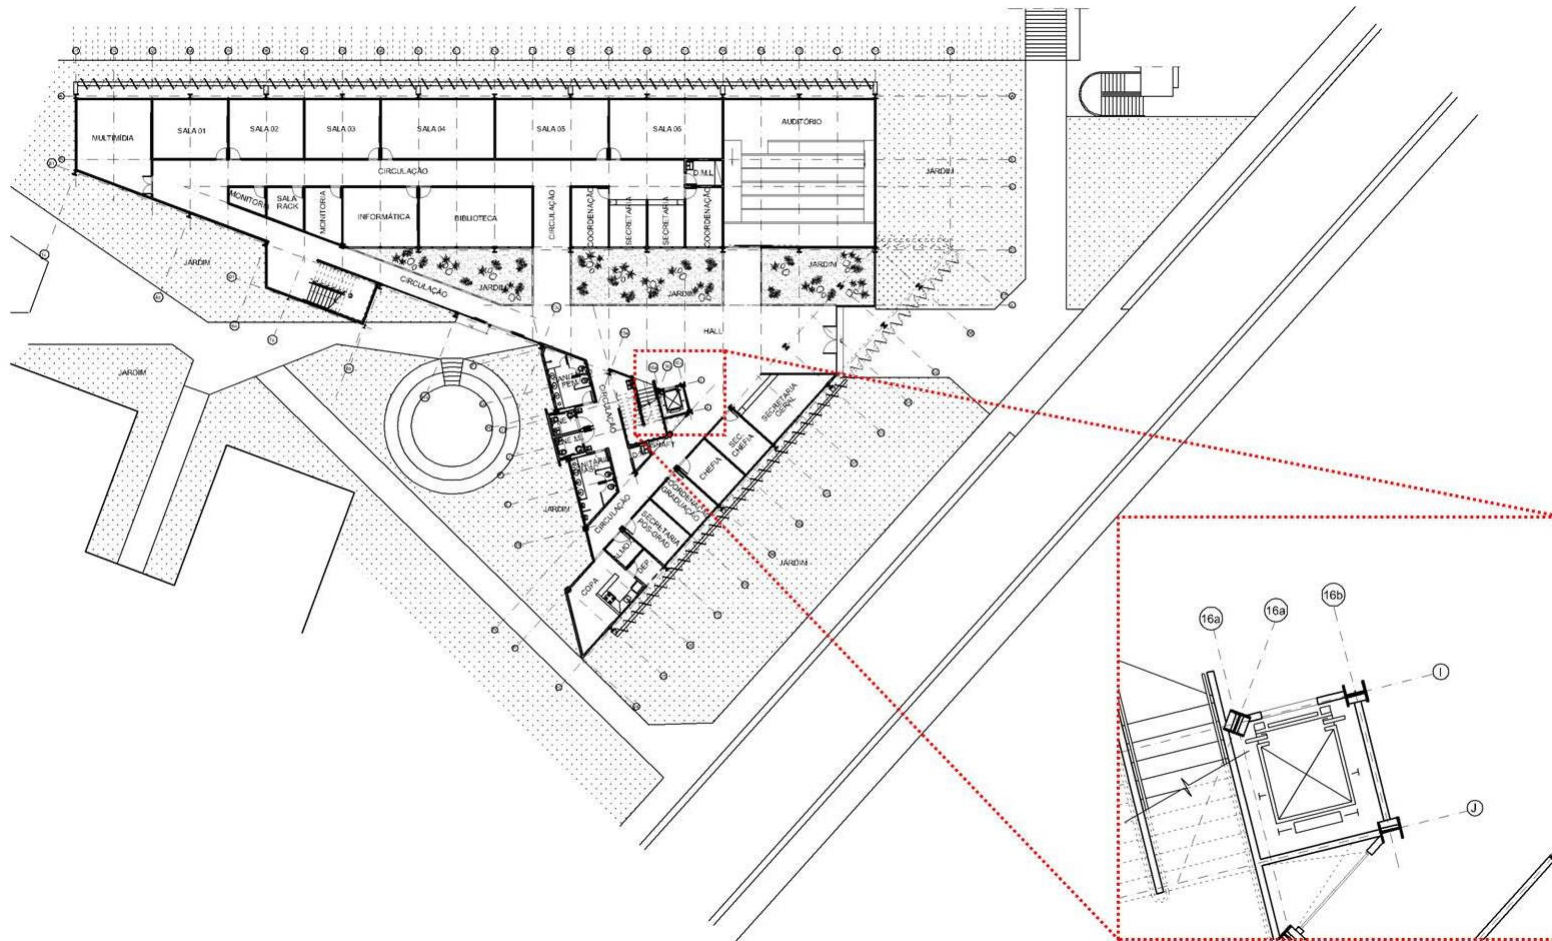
Planta da arquitetura (21/08/2009) do Edifício CCH-II, primeiro pavimento, detalhe do elevador
